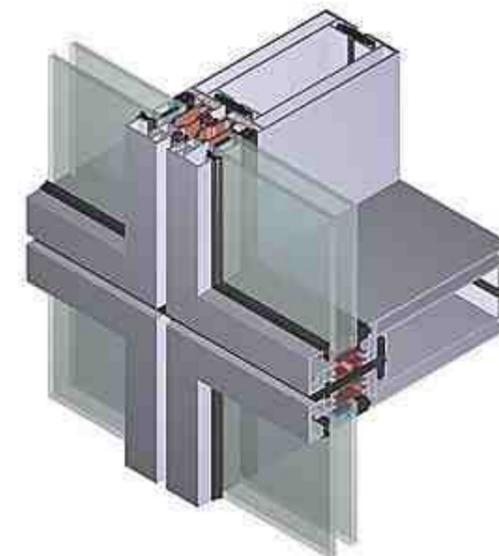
Systemausschnitt einer Elementfassade Aluprof Systems MB-SE75
